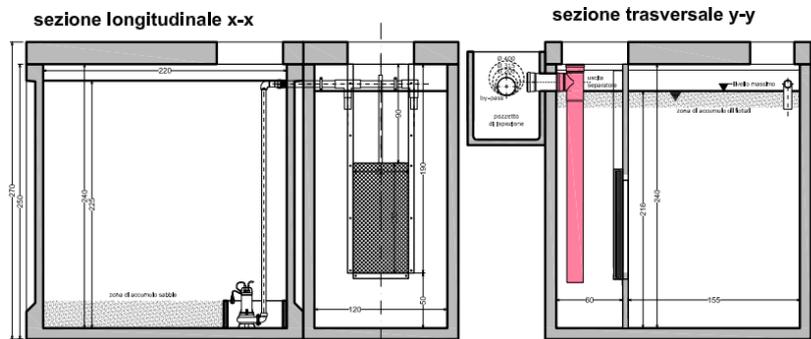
Sezioni longitudinale e trasversale dell'impianto
